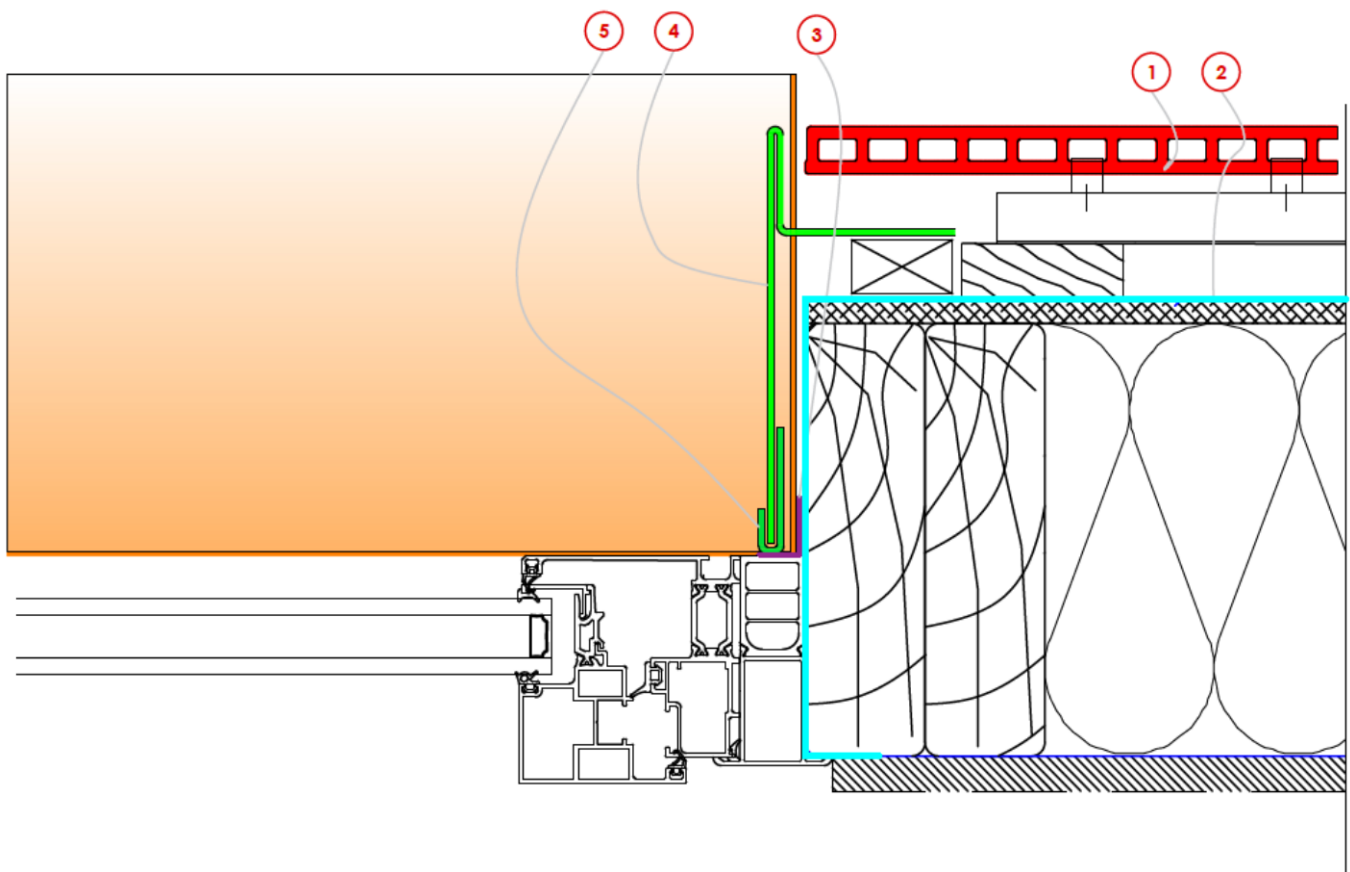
Pose à joints fermés sur COB avec membrane Dörken Delta Fassade – Coupe sur appui de baie
